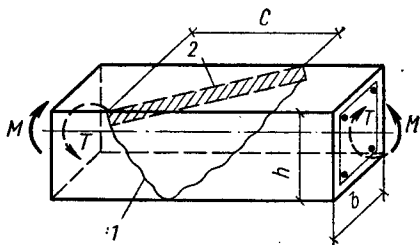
Схема разрушения элемента прямоугольного сечения, работающего на изгиб с кручением
